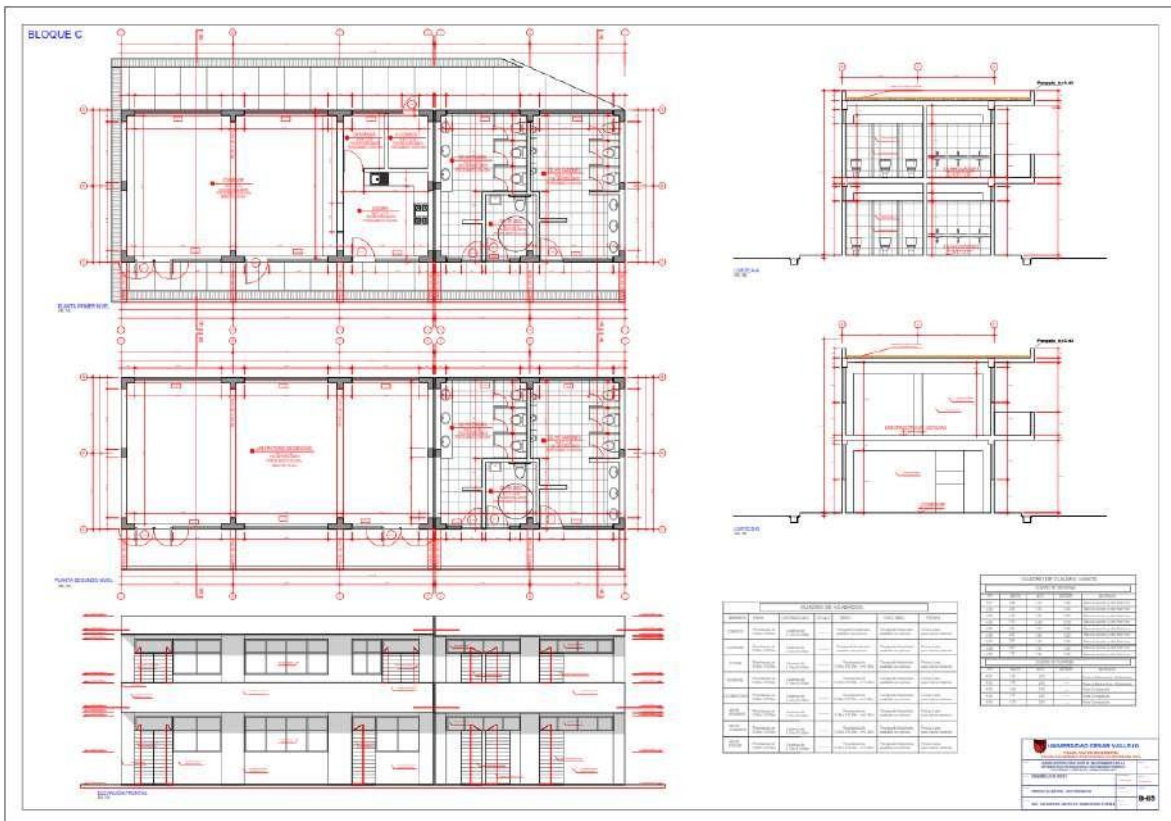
Plano D-05: Desarrollo Bloque C, 19-10-2021.
